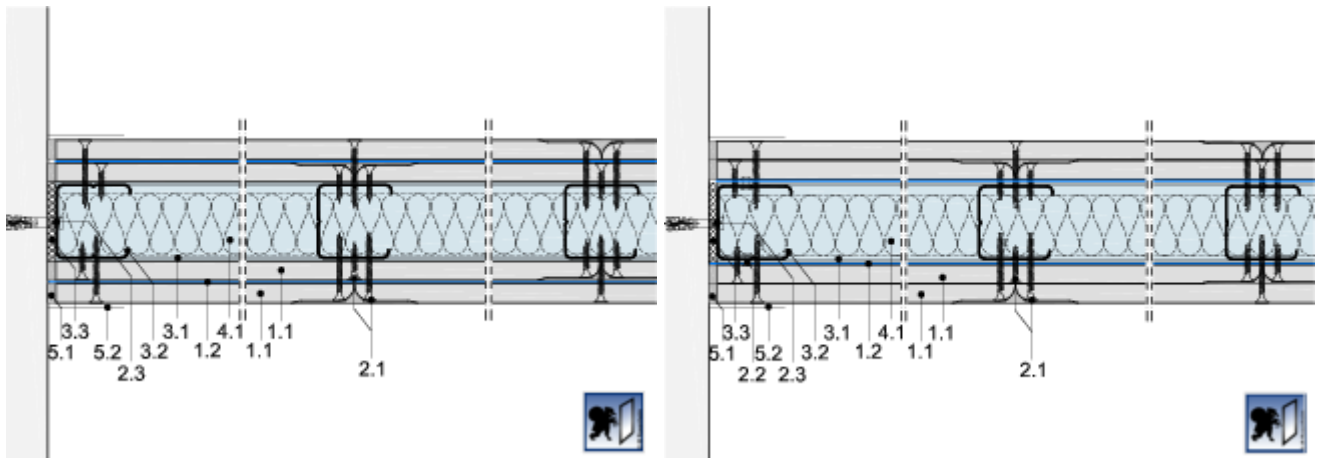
Gleitender Deckenanschluss Doppelständerwand RC 2 mit erhöhtem Schallschutz
